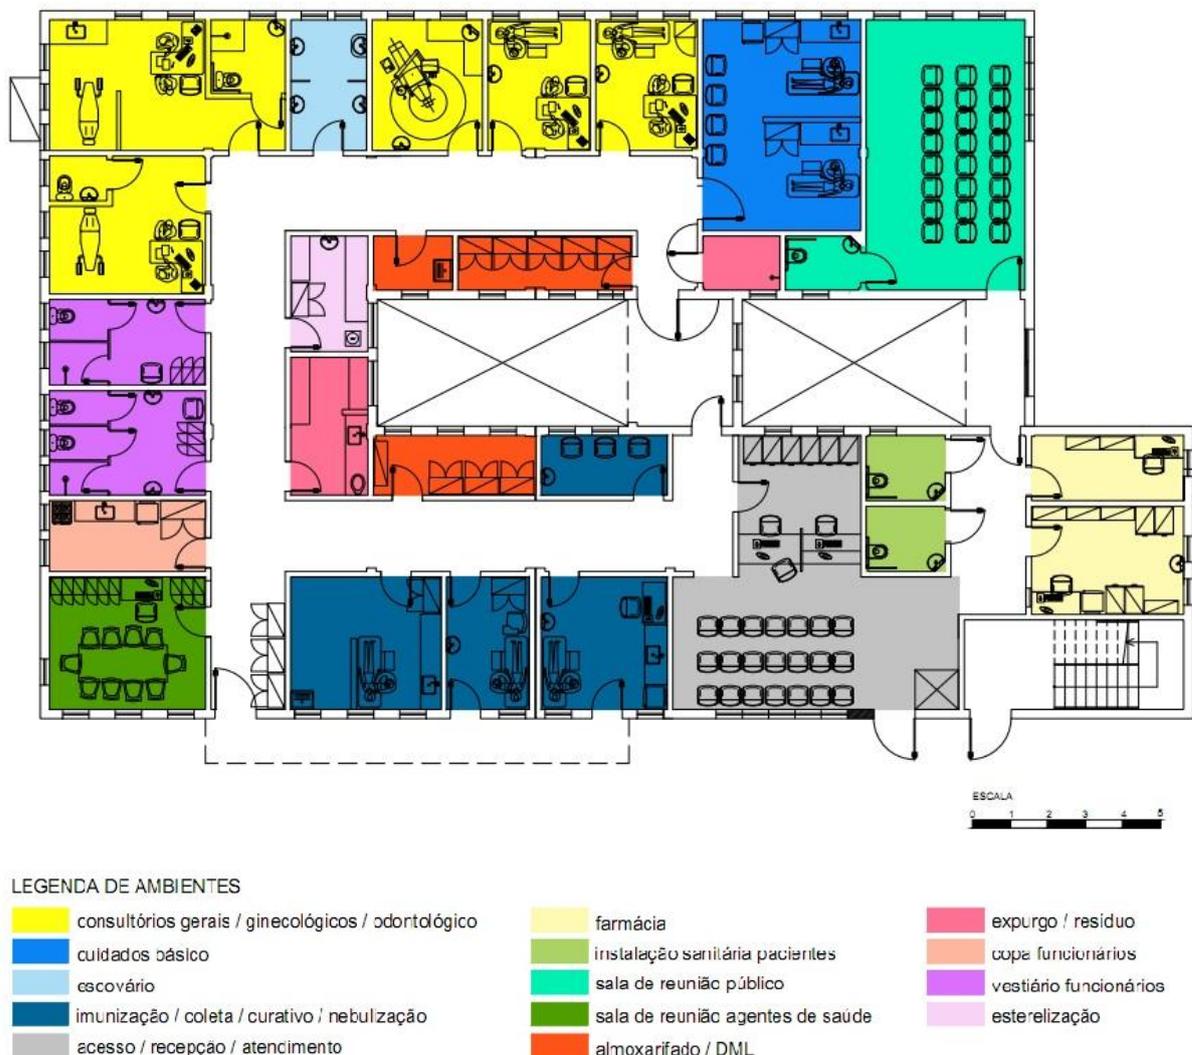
Planta UAPS Vila Ideal: primeiro pavimento
